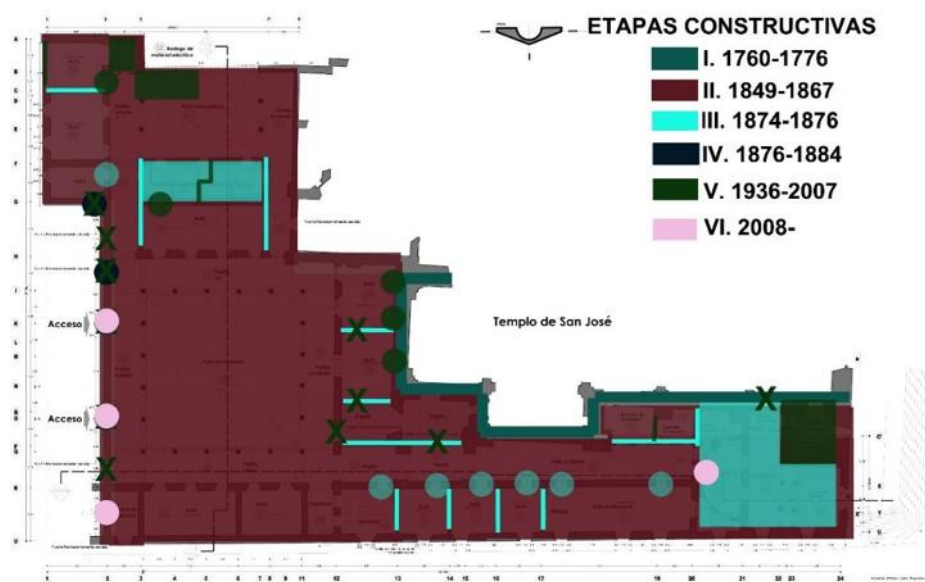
Sexta etapa (Planta baja)¹²⁹
